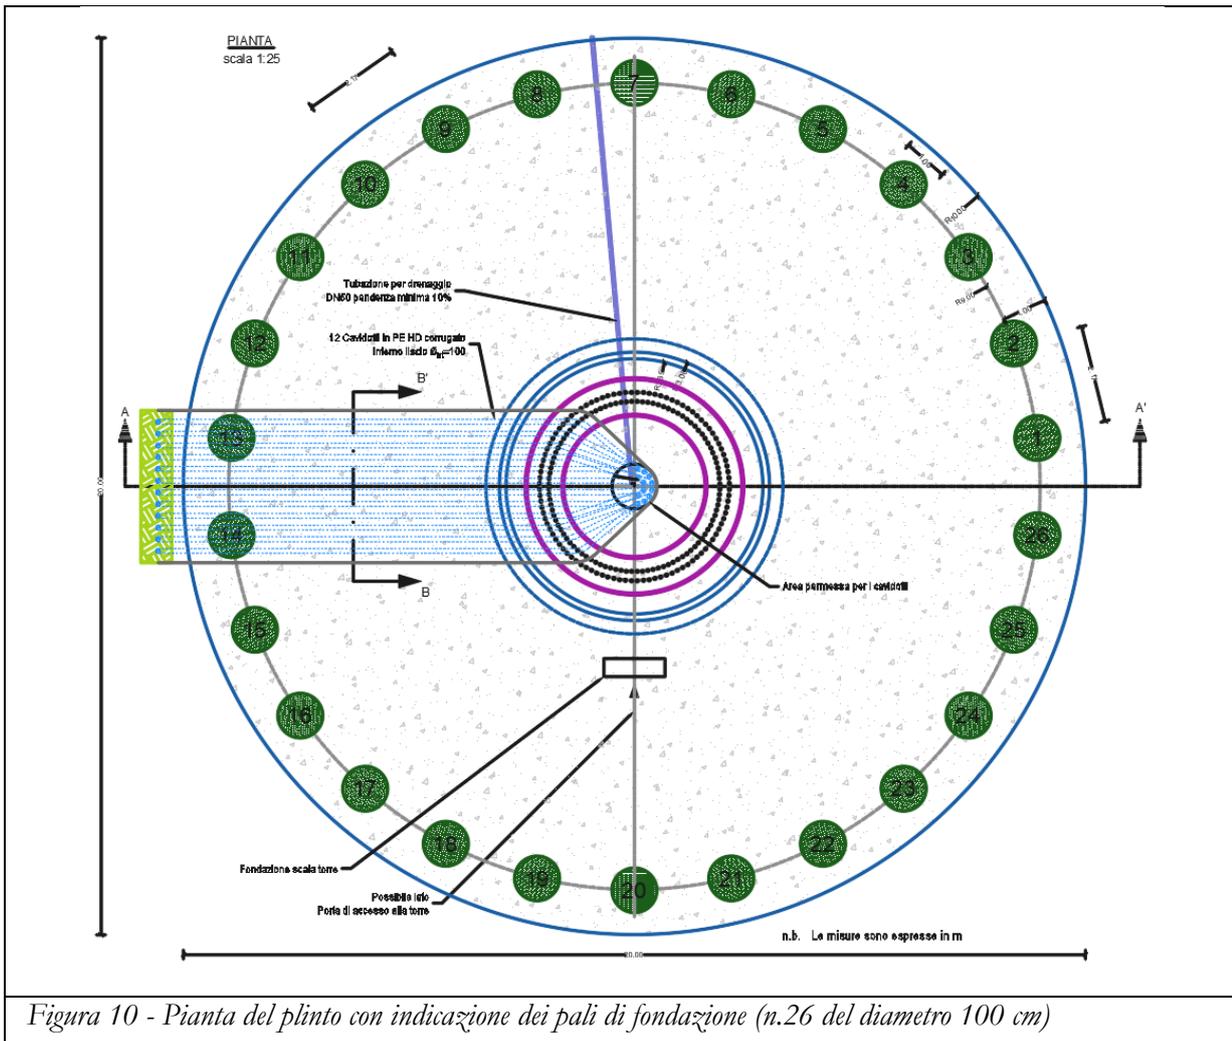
Pianta del plinto con indicazione dei pali di fondazione (n.26 del diametro 100 cm)
